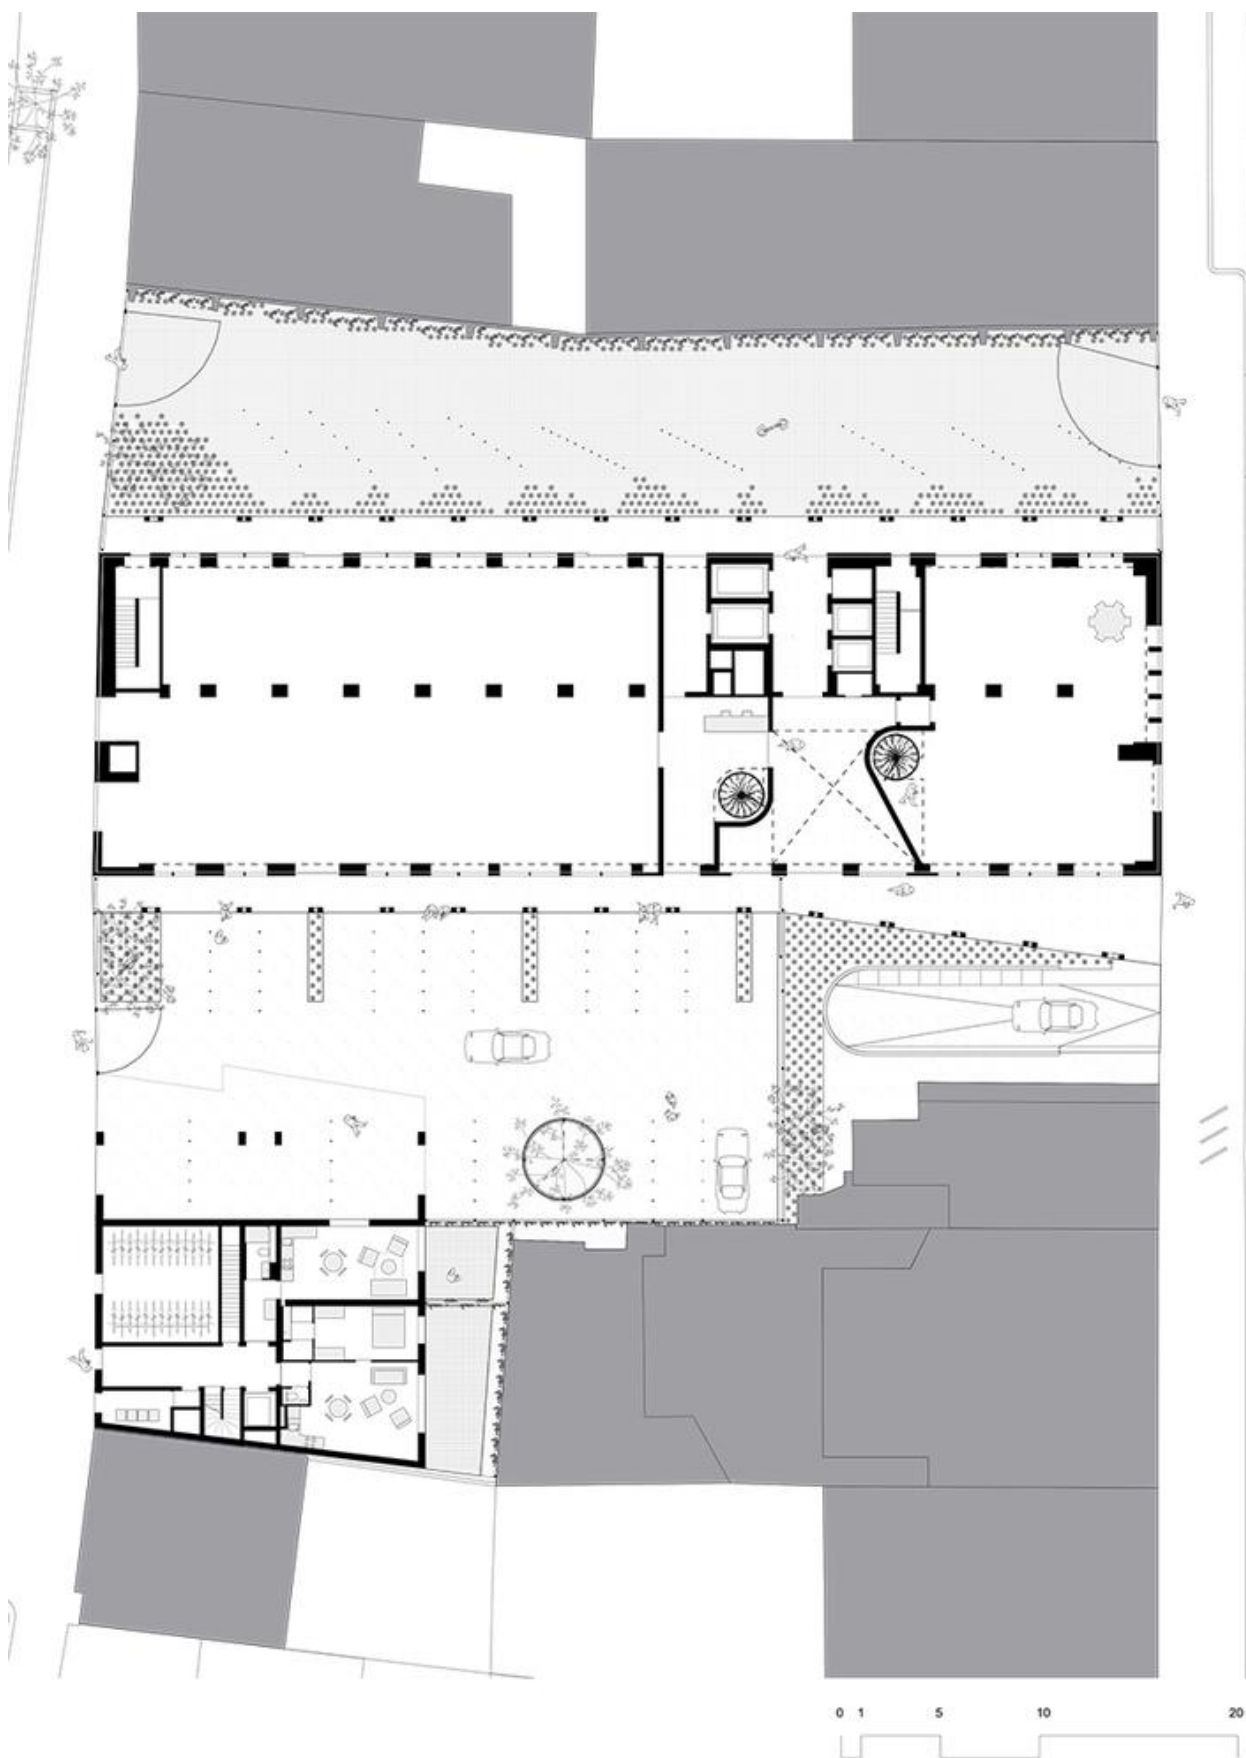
&Bogdan, *Plan RDC*, s.d., plan rez-de-chaussée, &Bogdan.
